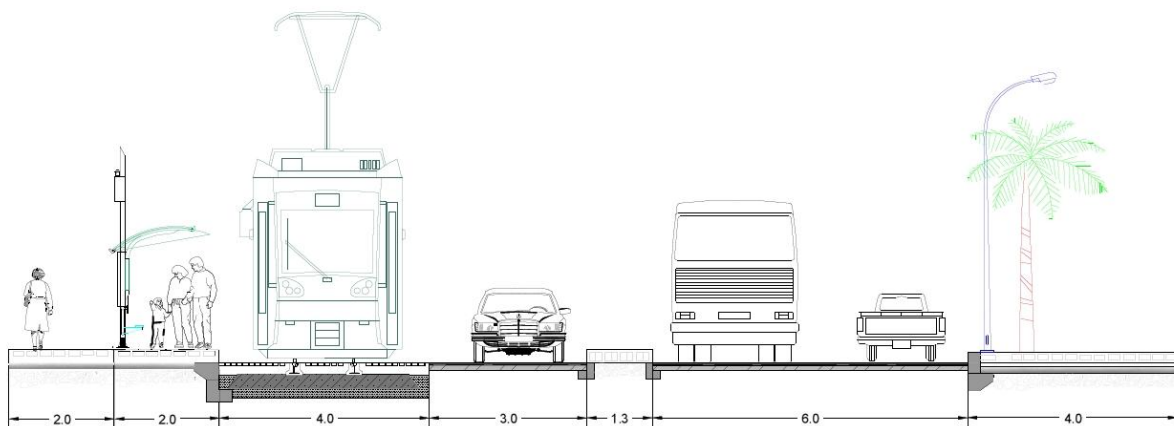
Sección tipo 1. (Fuente: elaboración propia autocad)
